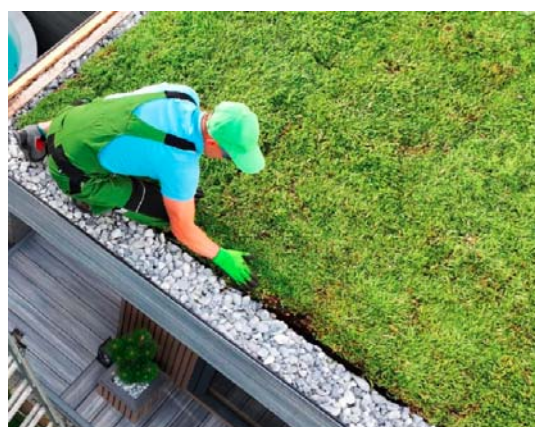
Techo verde. Fuente: Mundoclubhouse
